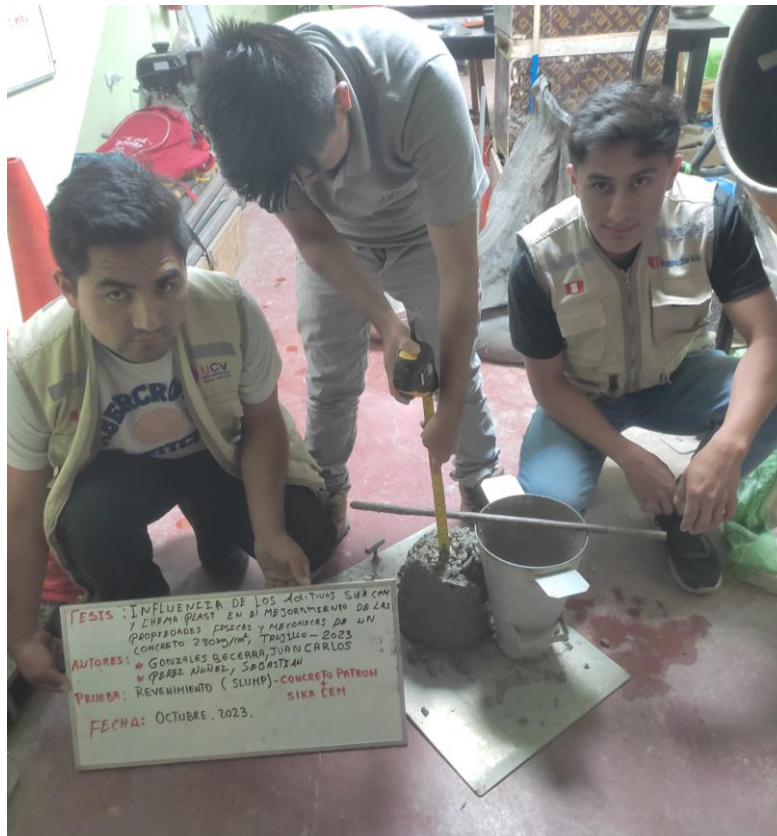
Prueba de SLUMP con aditivo Chema Plast
